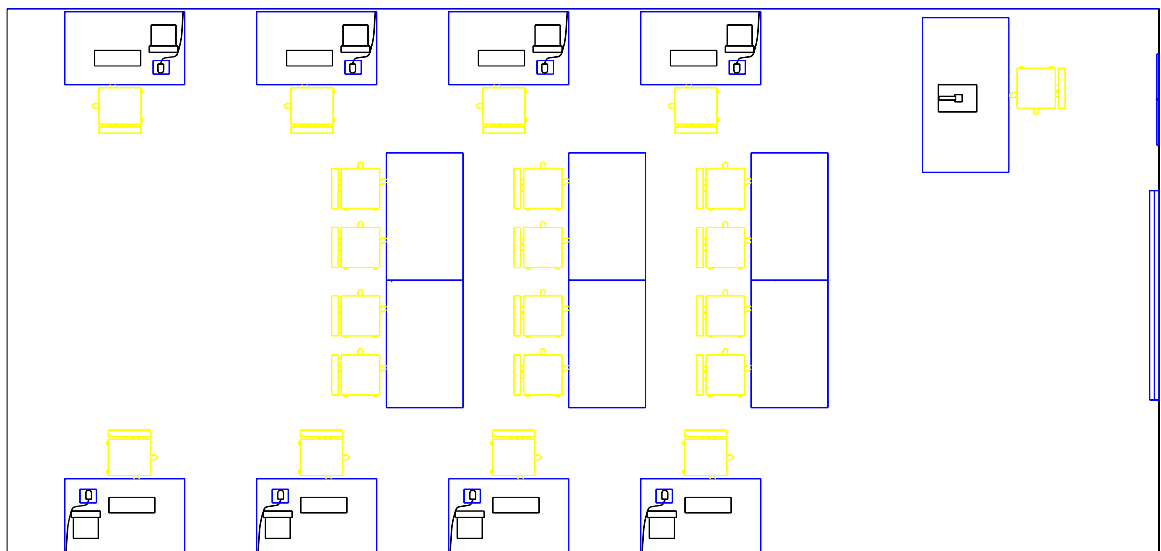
Вид сверху (длина зала 12 000, ширина 6 000)
